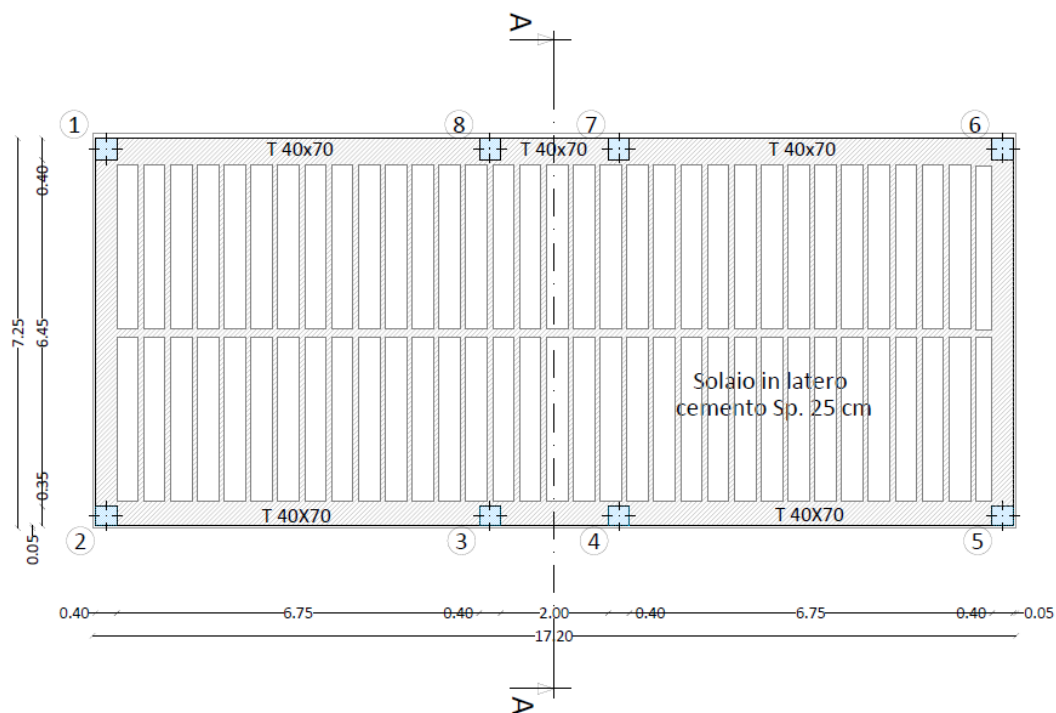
Blocco Q-Planimetria Struttura Piano Terra Esistente.
